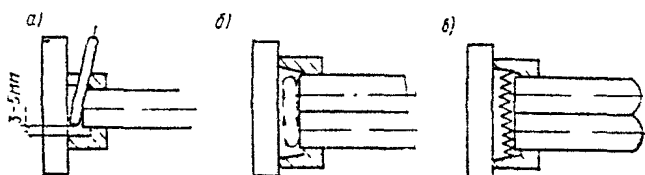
Многослойная сварка в медной форме тавровых соединений спаренных стержней с пластиной
